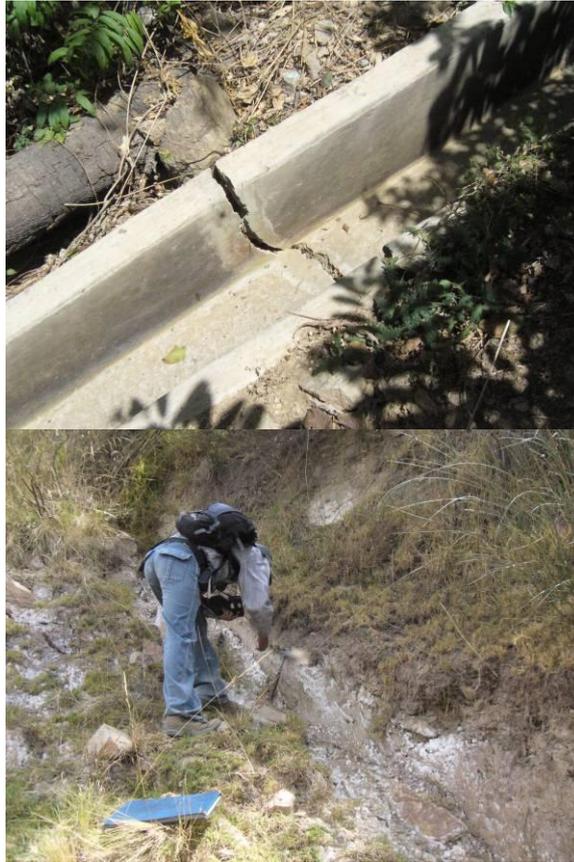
Vistas que muestran desplazamientos horizontales y verticales, evidenciando la reactivación por sectores del deslizamiento de Atupa-Linopuquio.
